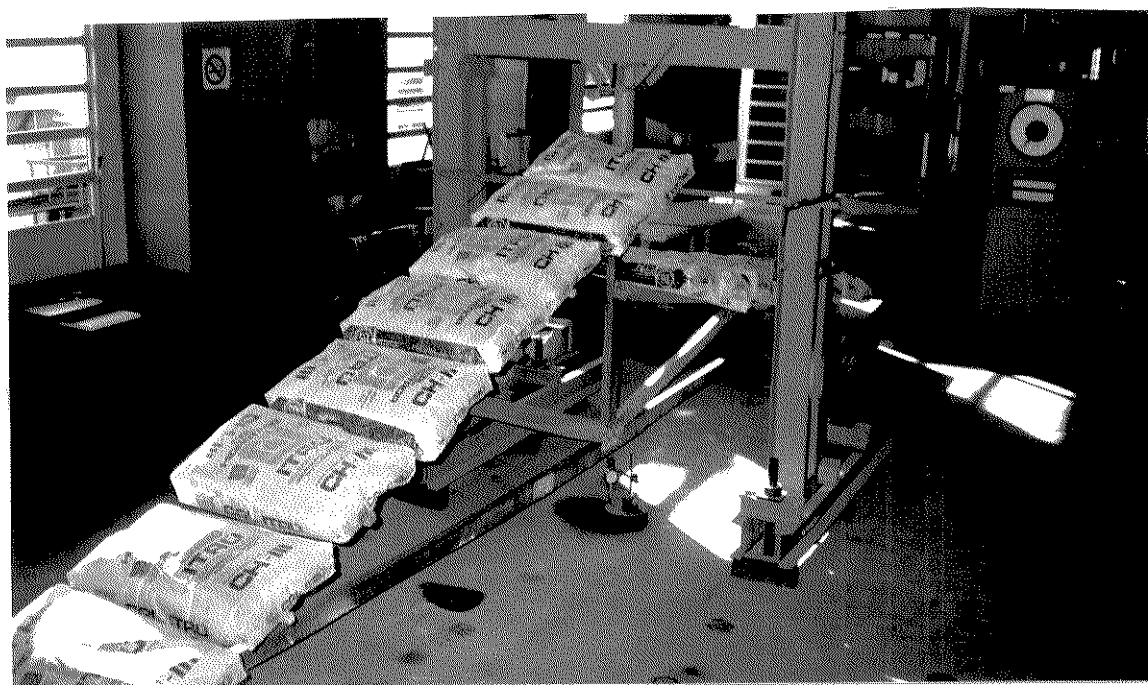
Ensaio do Pórtico-Treliça com a geometria proposta.
